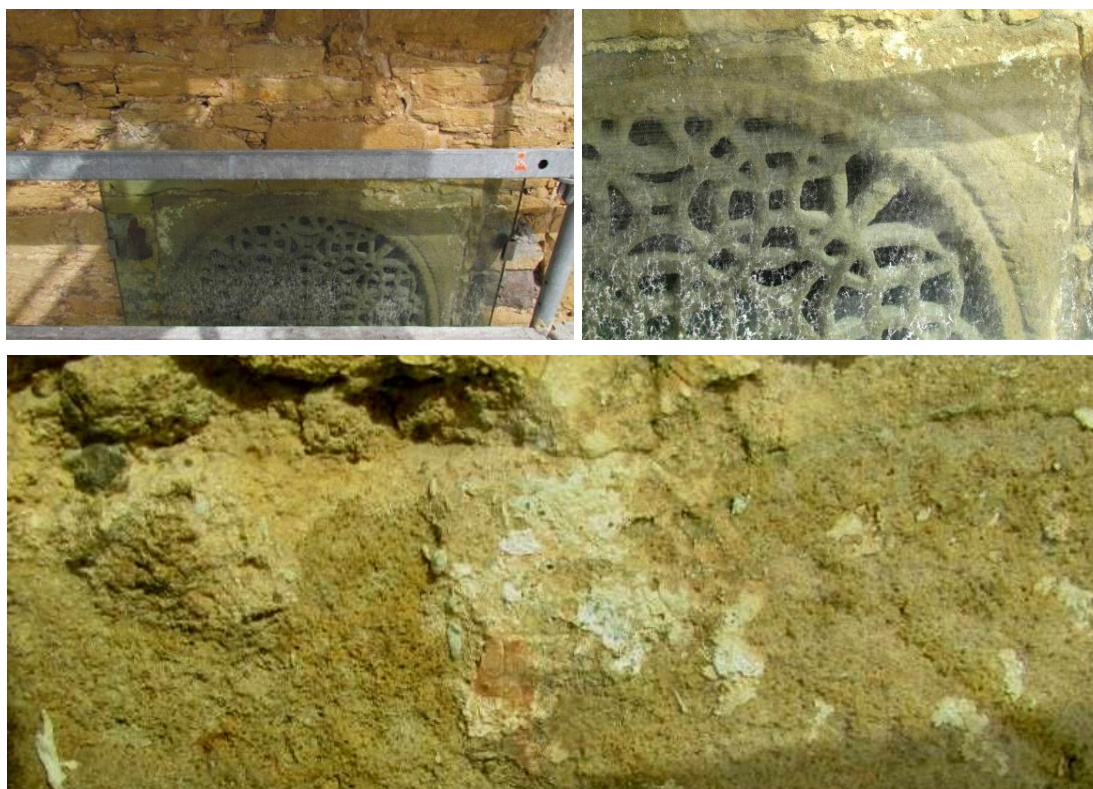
General y detalles de la ventana calada de la fachada sur con restos pictóricos en superficie.
